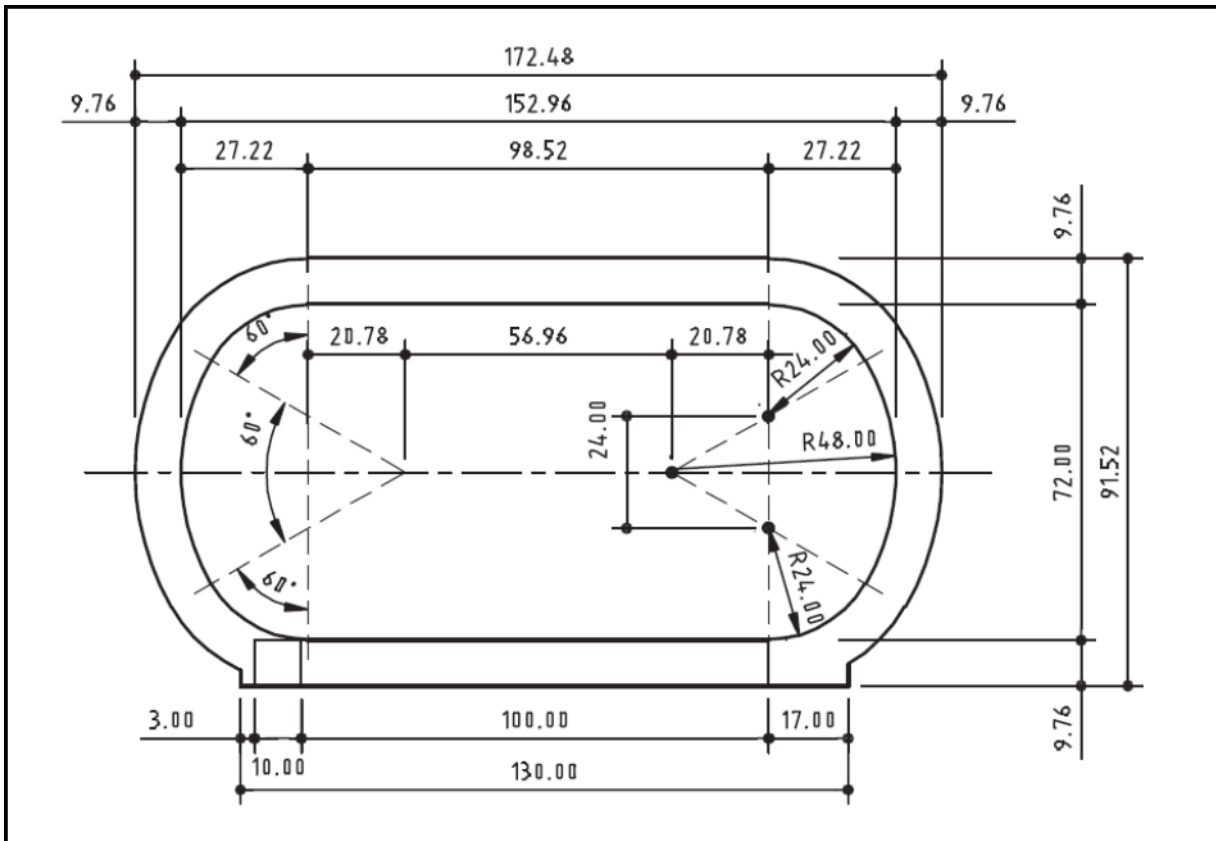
forme et dimensions de la piste de 400m à deux rayons en virage, R 48,00 et 24,00 (dimensions en m)
